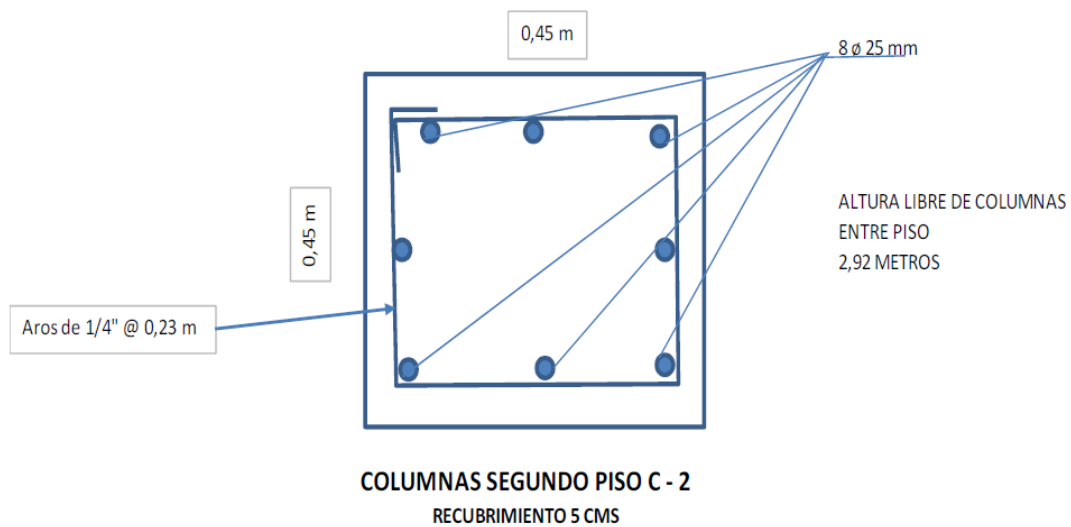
ColumnaC-2 Segundo Piso a Tercer Piso Edificio EPM Cartagena
